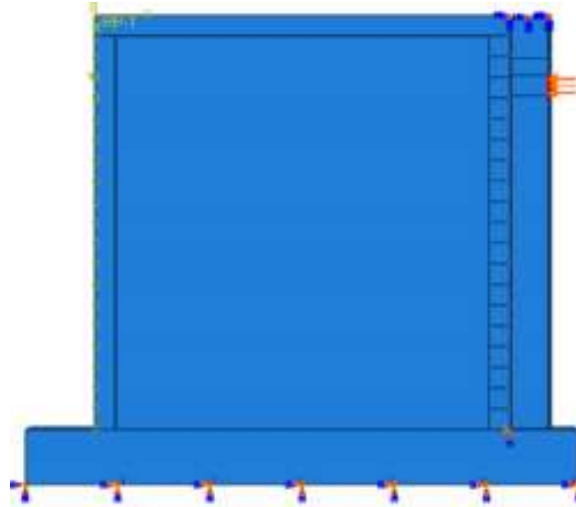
Aplicación de la fuerza lateral en el muro de mampostería
